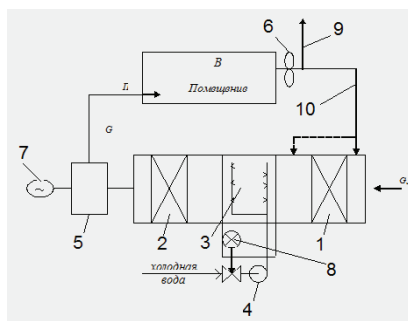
Схема прямооточной системы кондиционирования воздуха с применением первой рециркуляции: 1 - воздухонагреватель 1-го подогрева; 2 - воздухонагреватель 2-го подогрева; 3 - камера орошения; 4 - насос; 5 - вентиляционный агрегат; 6 - вытяжной вентилятор; 7 - электродвигатель; 8 - фильтр, 9 - отвод воздуха в атмосферу; 10 - отвод воздуха на рециркуляцию.
